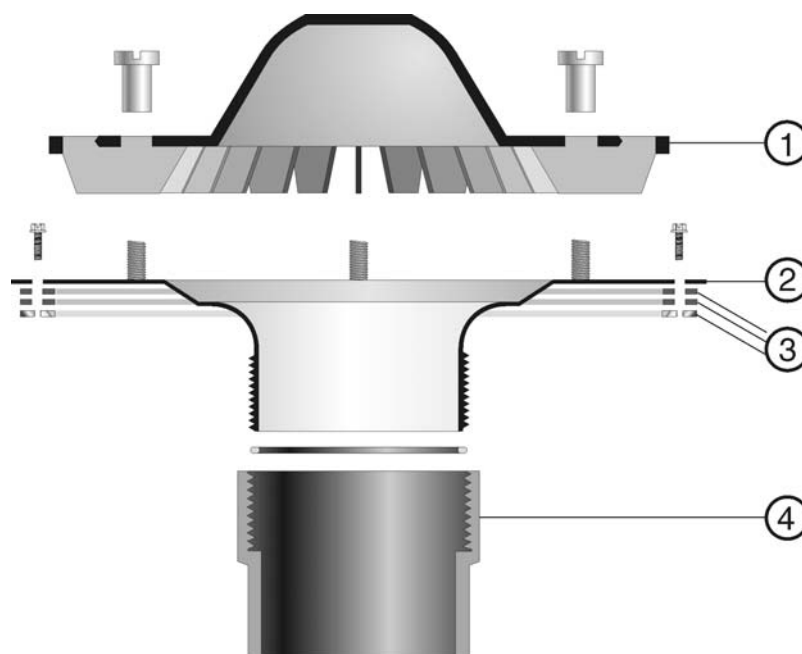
Installatievoorbeeld Wavin QS 75 – type bitumenmontage
